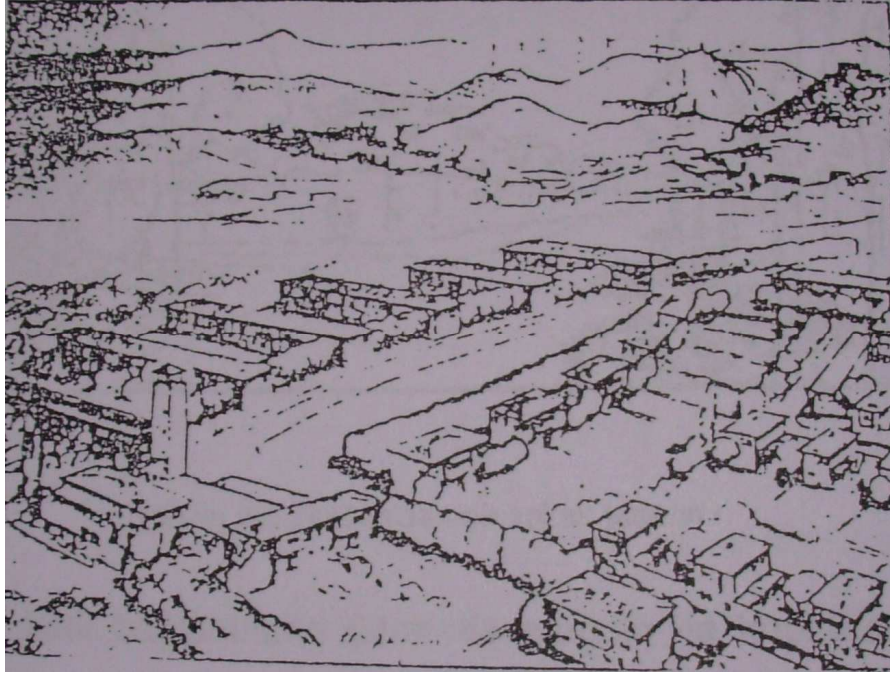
Bahçelievler’de uygulanan plan ve tespitler (Uçar ve Özsoy 2006)
